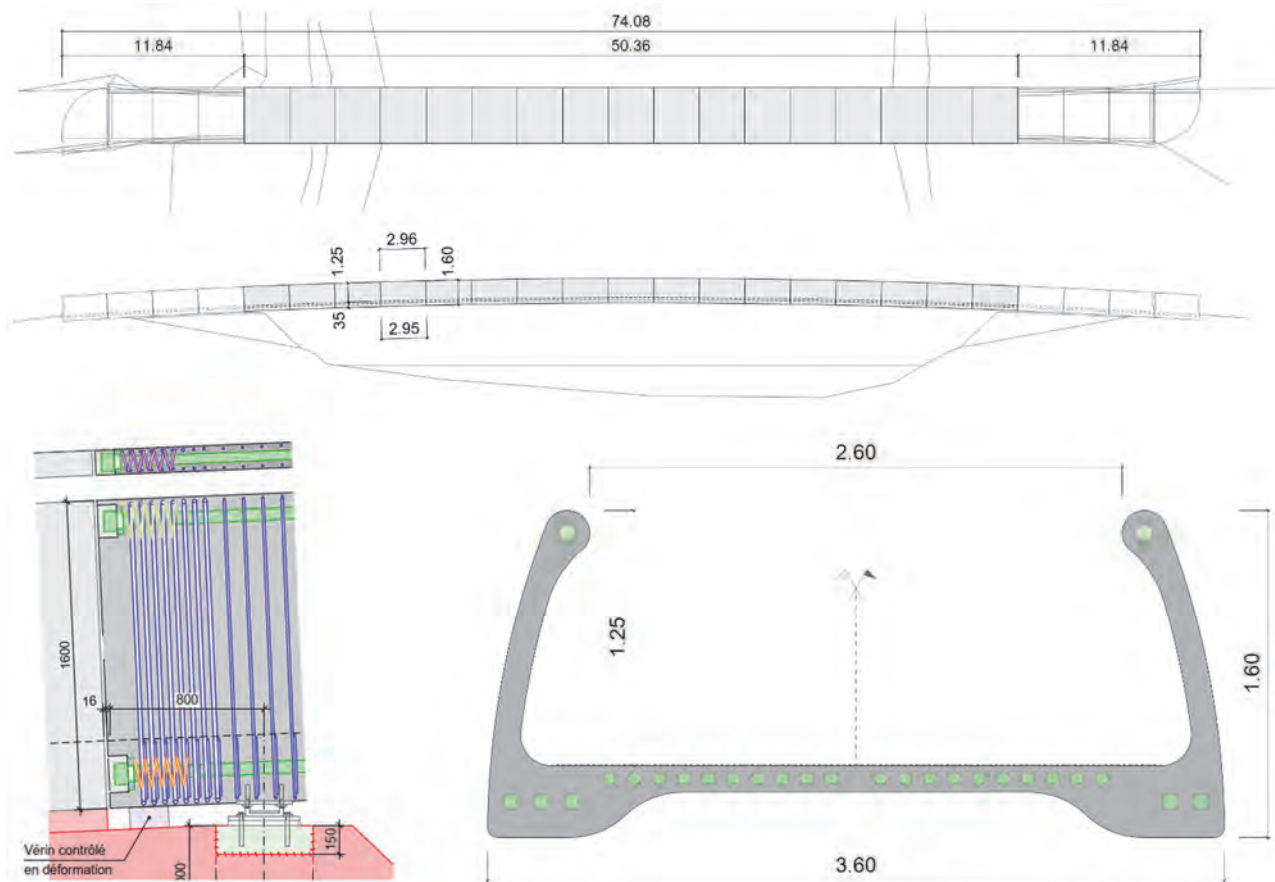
Situation, élévation, coupe longitudinale d'élément de bord et coupe transversale de l'auge
